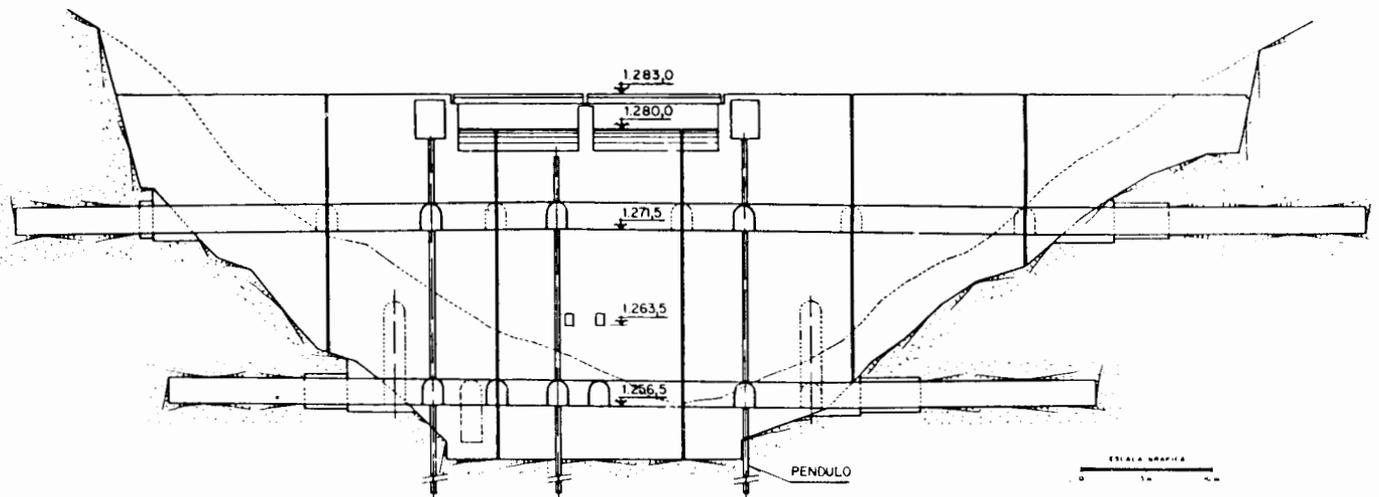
(c) Perfil longitudinal por eje galerías.
